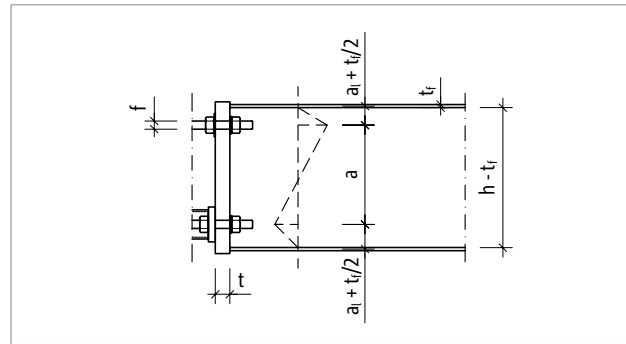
Platine frontale affleurante T type S : calcul des valeurs géométriques d'entrée ; vue en coupe
